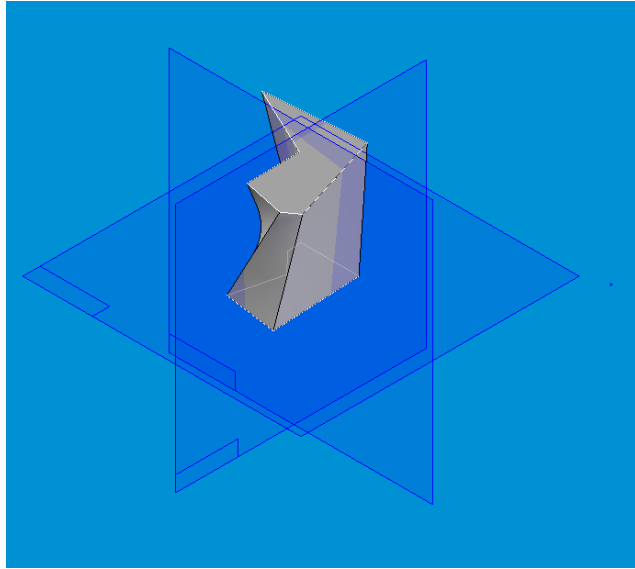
Ricostruzione geometrica del pilastro 23.
